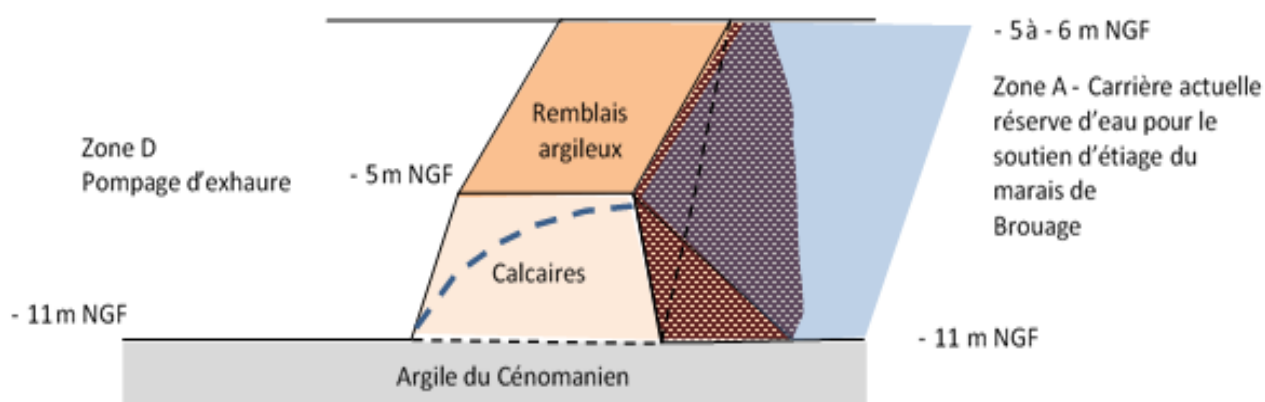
Schéma des aménagements entre la carrière actuelle (Zone A) et la zone D
